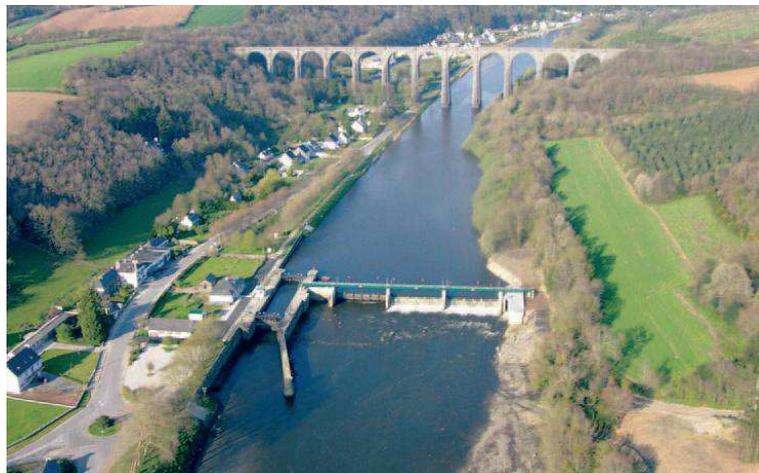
Le barrage de Guily-Glas à Port-Launay (Photo du Conseil Général du Finistère)
